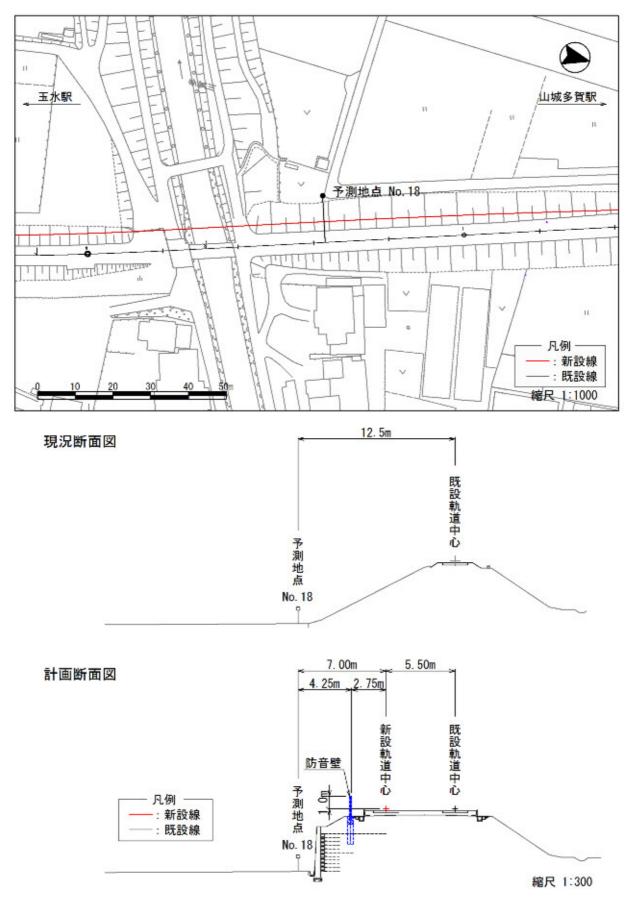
(18) 予測平面・断面図(予測地点 No.18)
